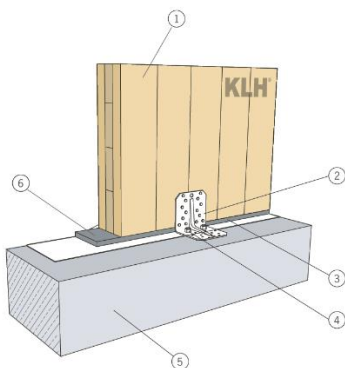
Узел примыкания стеновой панели к фундаменту с помощью Г-образной крепежной пластины: 1- внешняя стеновая панель; 2 - Г-образная крепежная пластина; 3,6 - низкоусадочная лента; 4 - крепежные анкеры; 5 - фундаментная плита.
